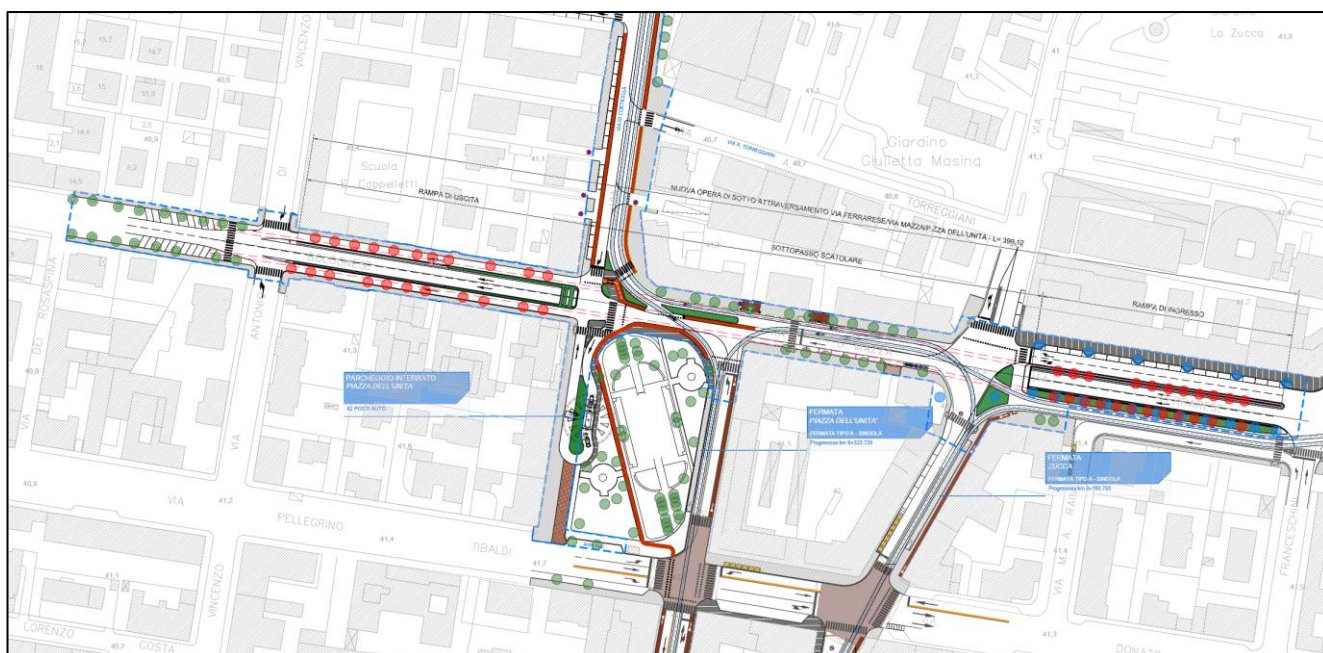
planimetria progettuale del sottopasso e del parcheggio
